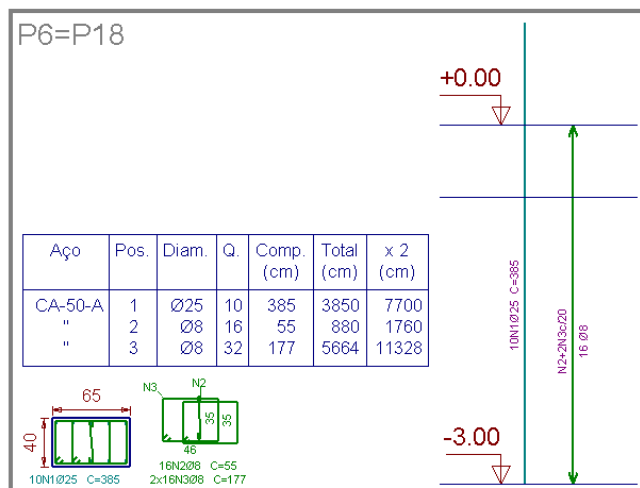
Detalhamento do P18 entre a fundação e o 1º Pav. – CYPECAD 2008 [5].
